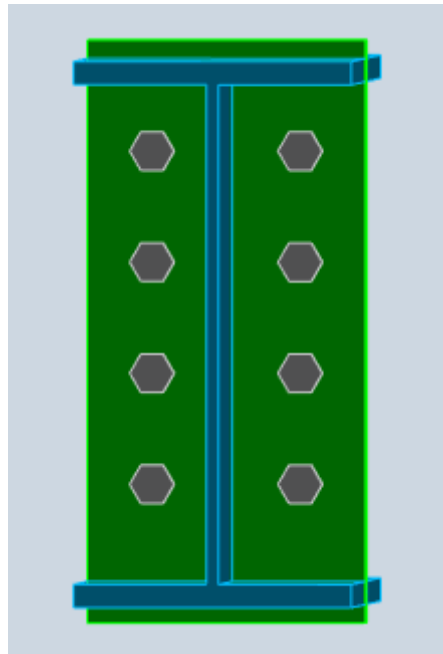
Assemblage Poteau- Poteau (HEA600-HEA600)
